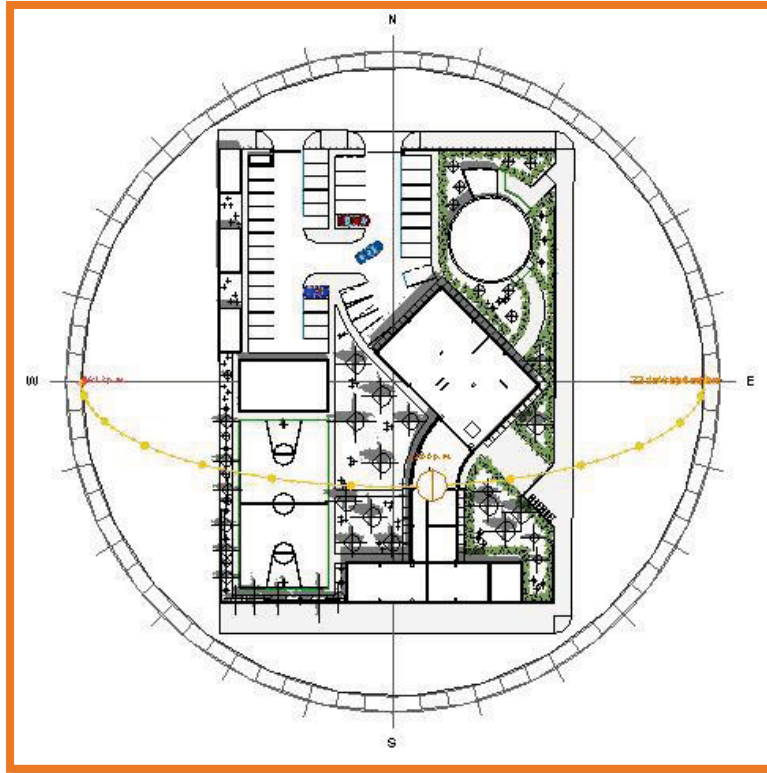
Soleamiento durante el equinoccio de otoño en planta.
